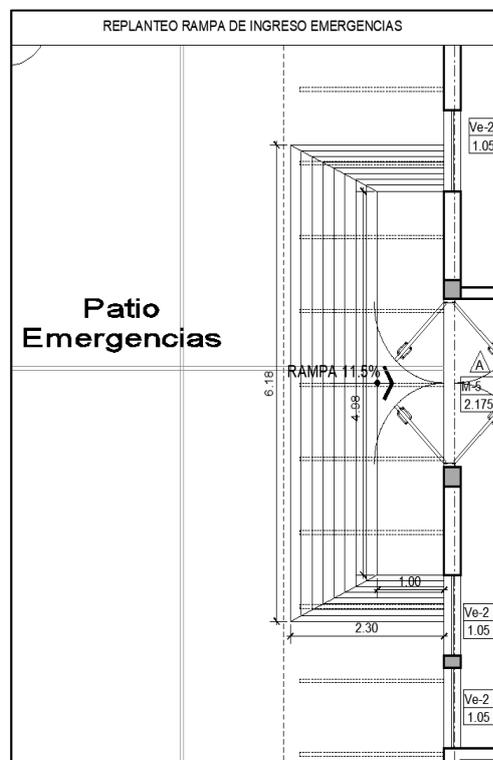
Plano de replanteo de rampa de acceso a emergencia
